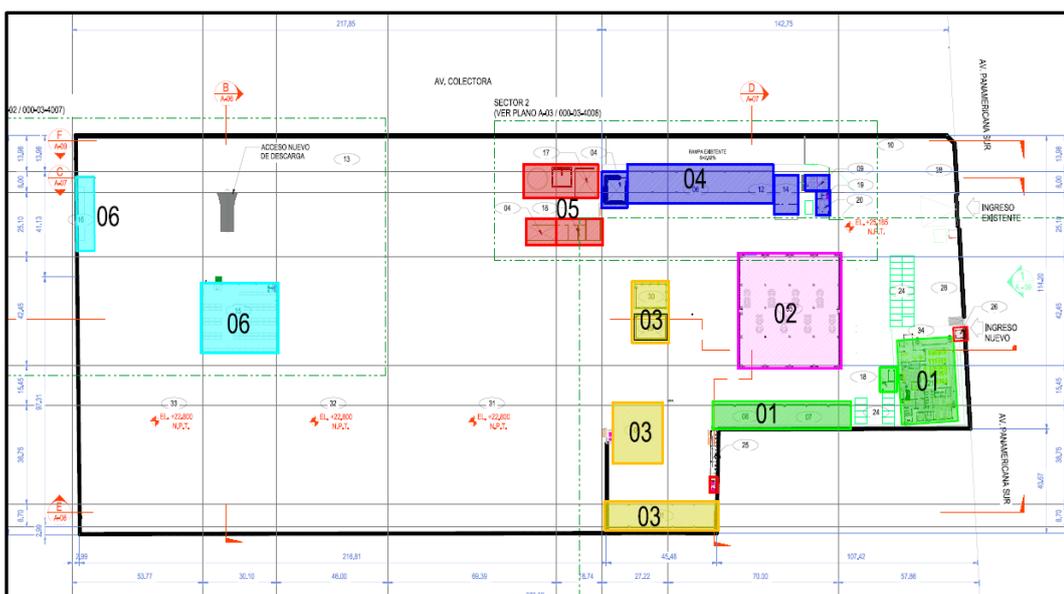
Plan de Sectorización aplicado en el Proyecto Construcción de la Planta Pucusana III Etapa
